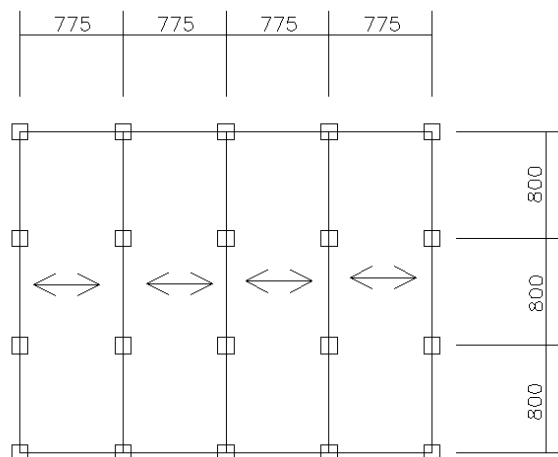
Configuração estrutural da alternativa 2 (medidas em “cm”).
